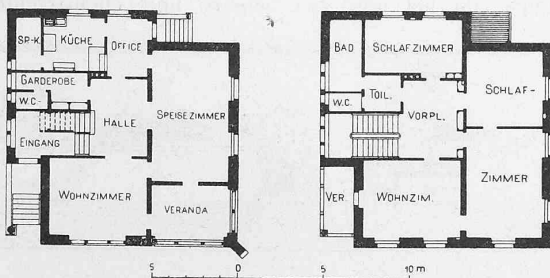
Grundrisse der Villa an der Böcklinstrasse in Zürich V. Masstab 1 : 400.
